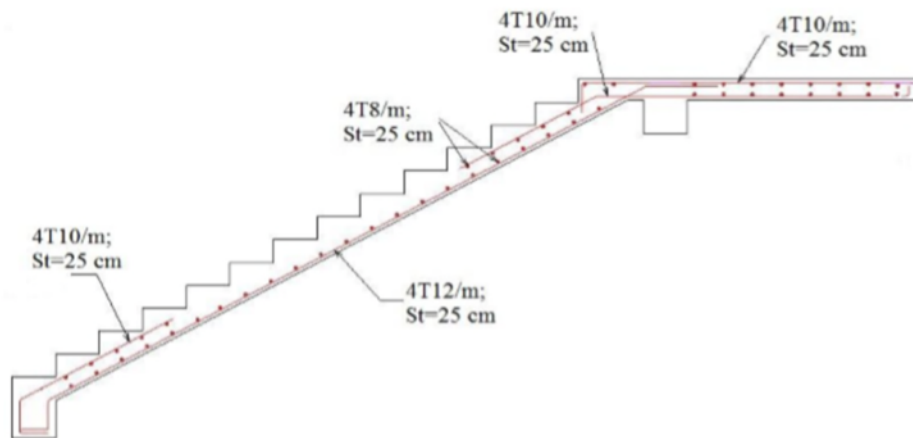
Schéma de ferrailages de l'escalier type 1
